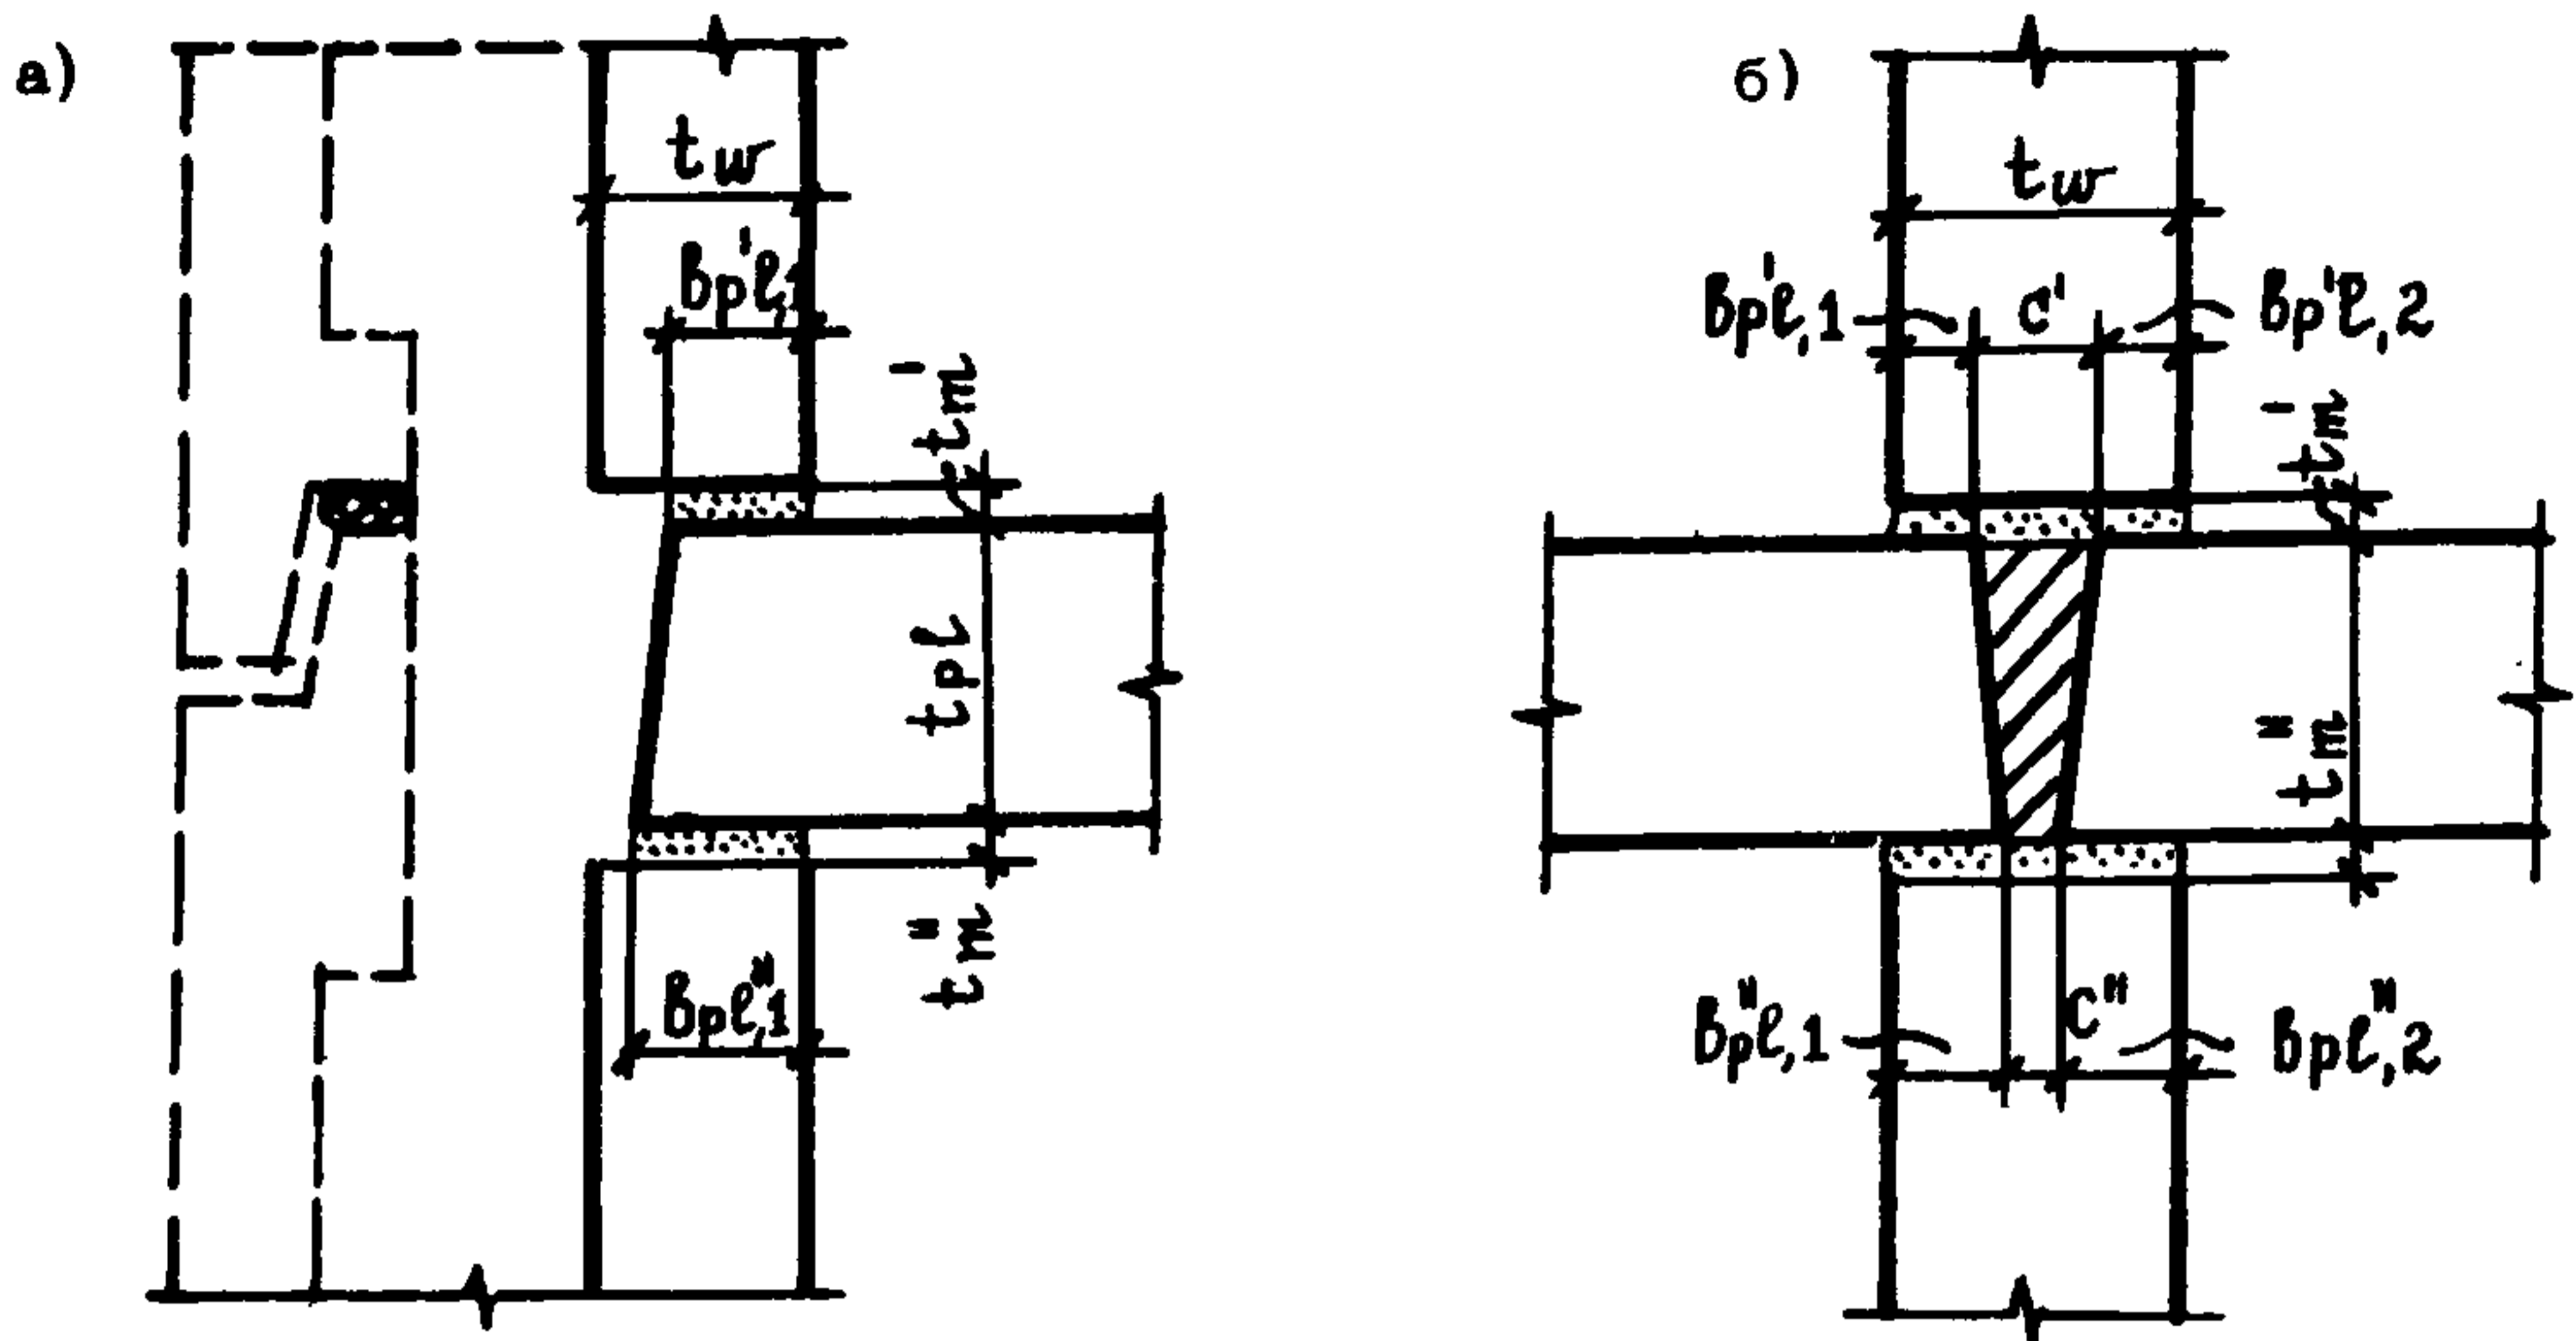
Платформенные стыки с односторонним (а) и двусторонним (б) опиранием плит перекрытий
